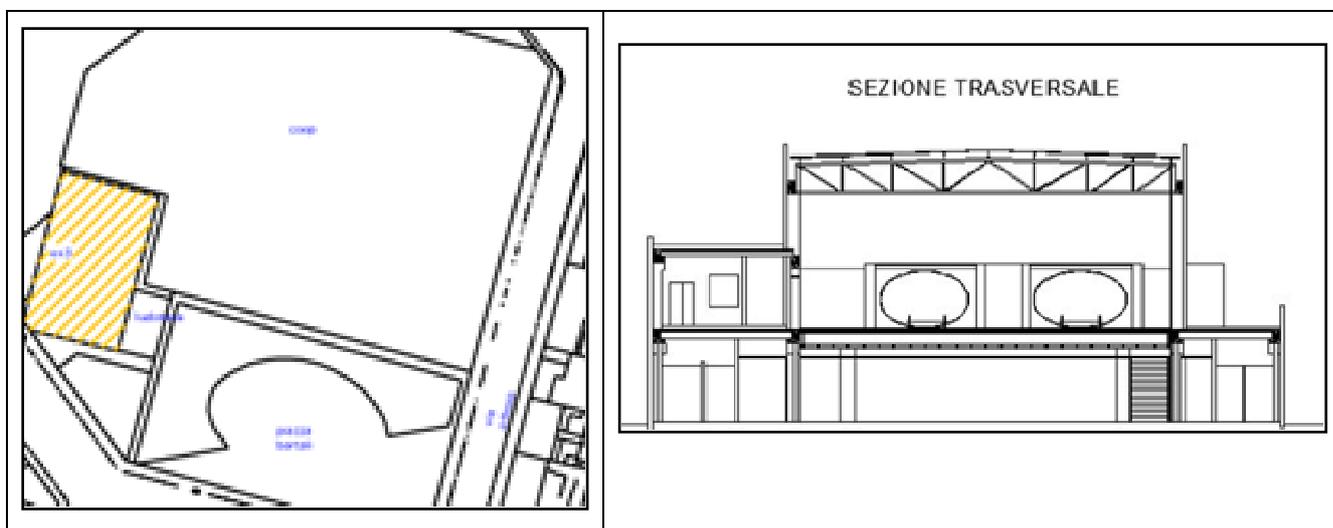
Planimetria dell'area con ubicazione dell'intervento, scala 1:5.000, e sezione trasversale dell'edificio esistente
